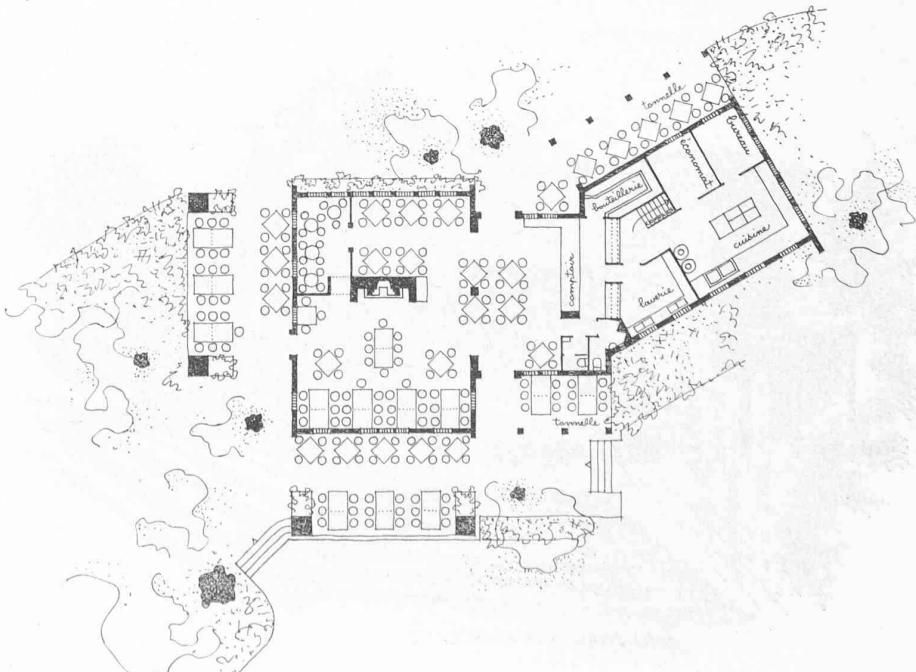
La «Pinte fribourgeoise». Plan. Echelle 1 : 300.
